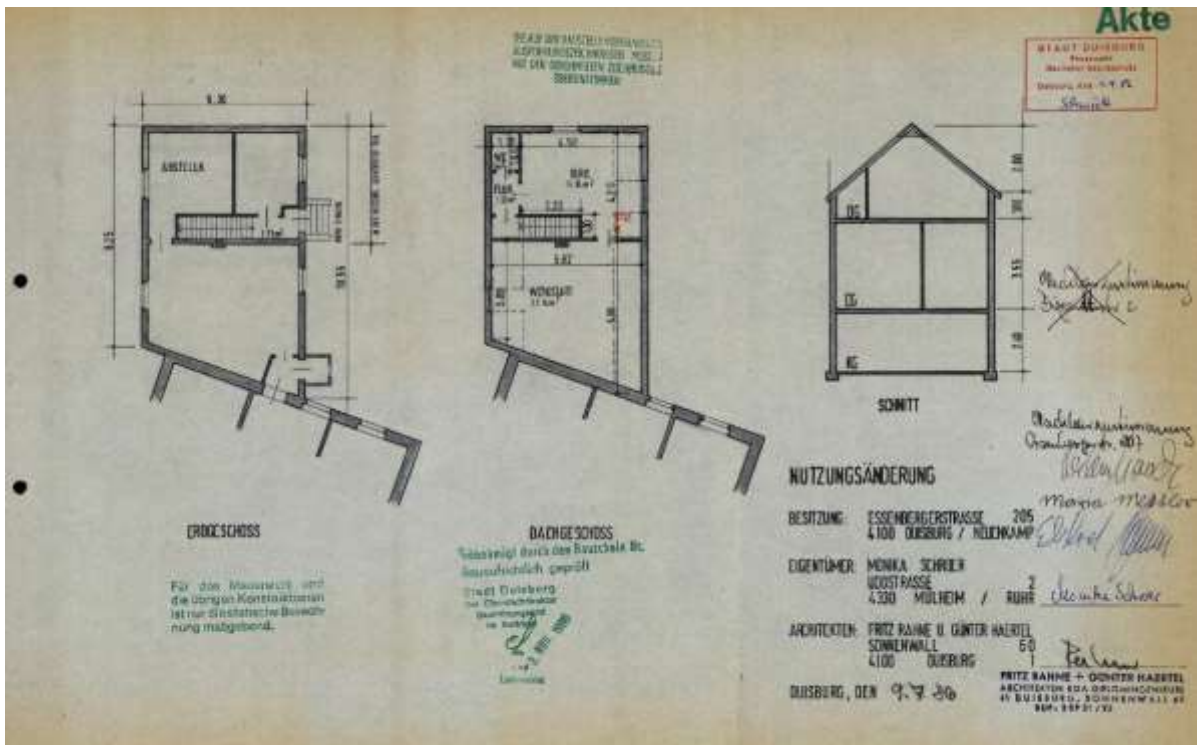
Grundrisszeichnungen Anbau (vom Nutzungsänderungsantrag Anbau) Quelle: digitale Bauakte Stadt Duisburg
